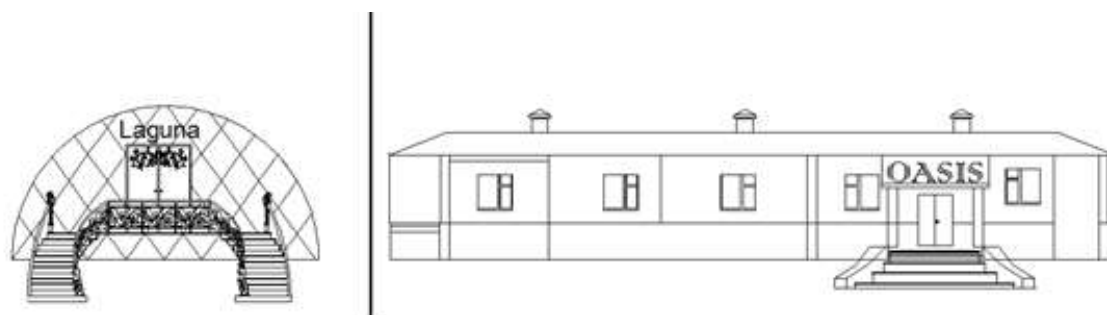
Фасады зданий (слева - купольное, справа - прямоугольное)
